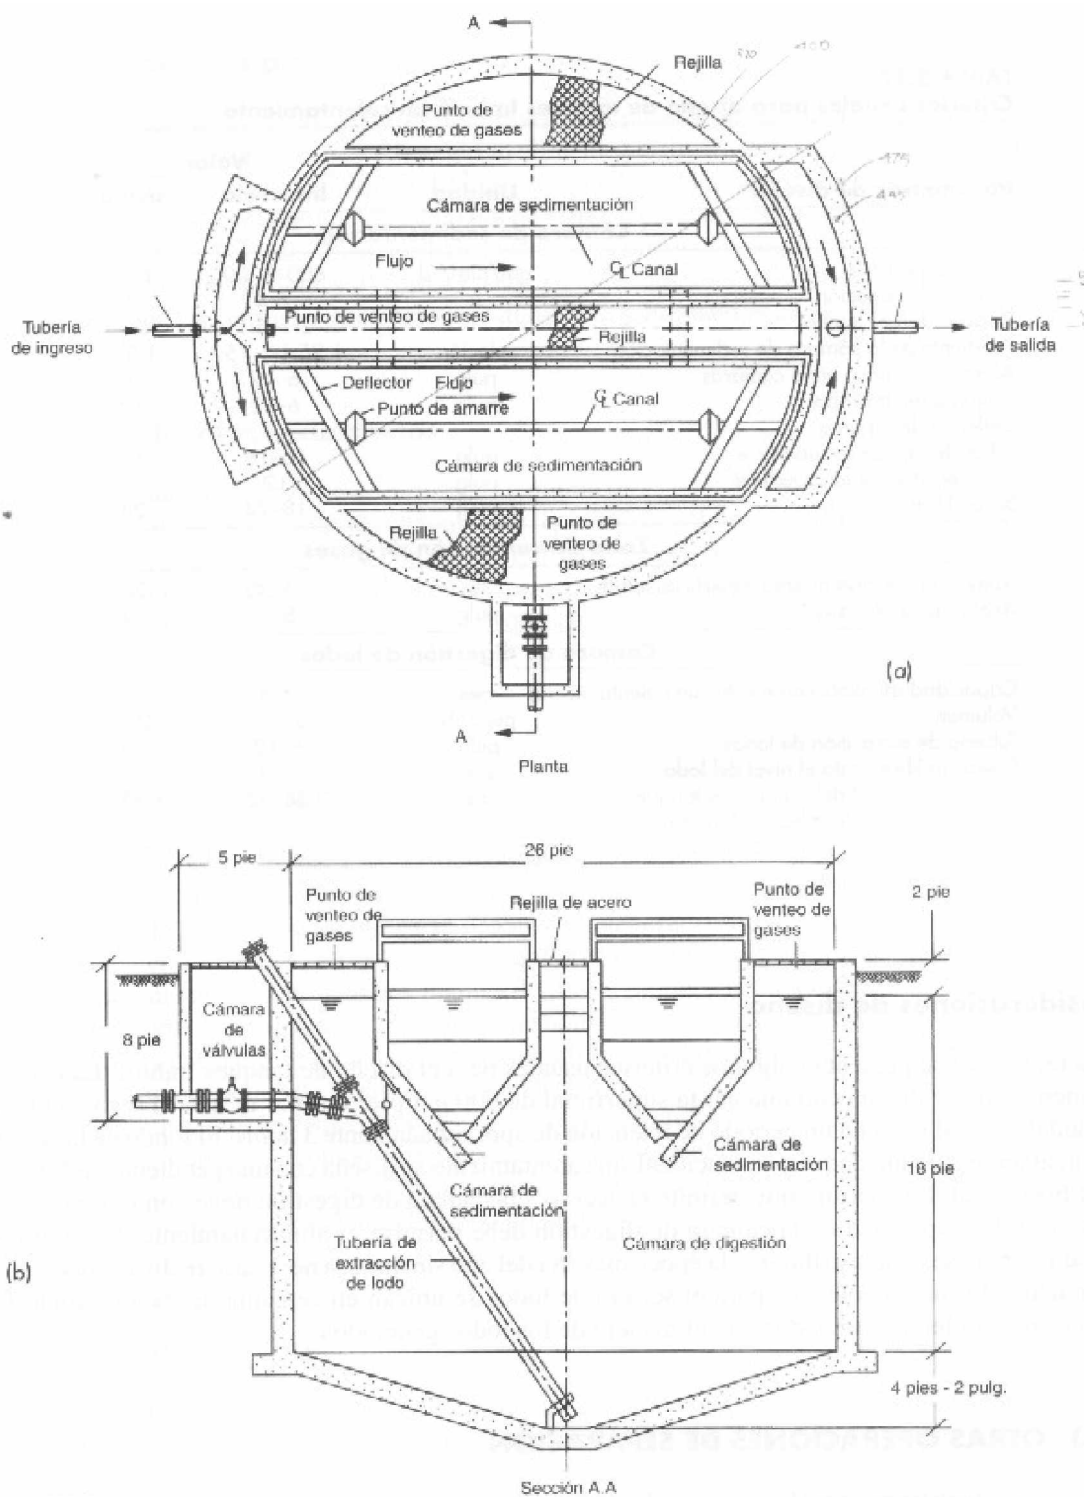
Tanque Imhoff circular. (a) planta, (b) sección transversal.
